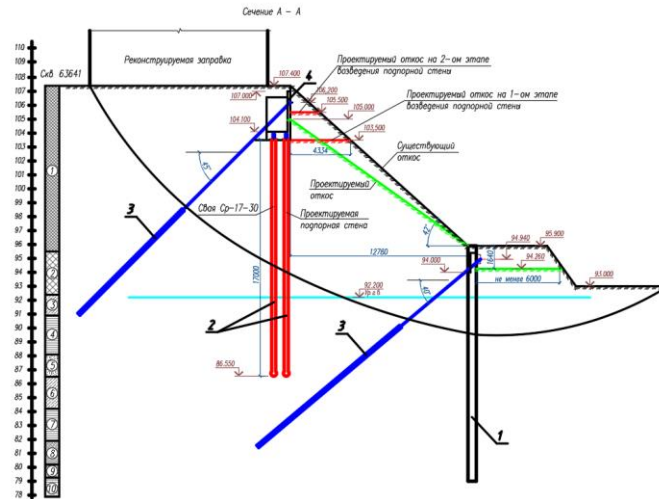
Поперечное сечение прислоненного откоса с противополозновыми заглубленными железобетонными конструкциями: 1 – существующая подпорная стена из бурунабивных свай диаметром 500,0 мм; 2 – буронагрейционные сваи ЭРТ усиления основания в два ряда; 3 – грунтовые анкера ЭРТ усиления склона; 4 – монолитная уголковая железобетонная подпорная стена.
